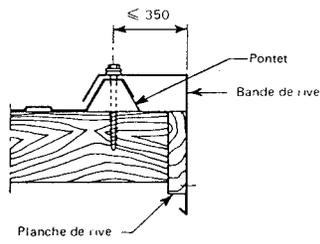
Bande de rive - Fixation sur panne bois par poutrelle et tire-fond - Coupe verticale
